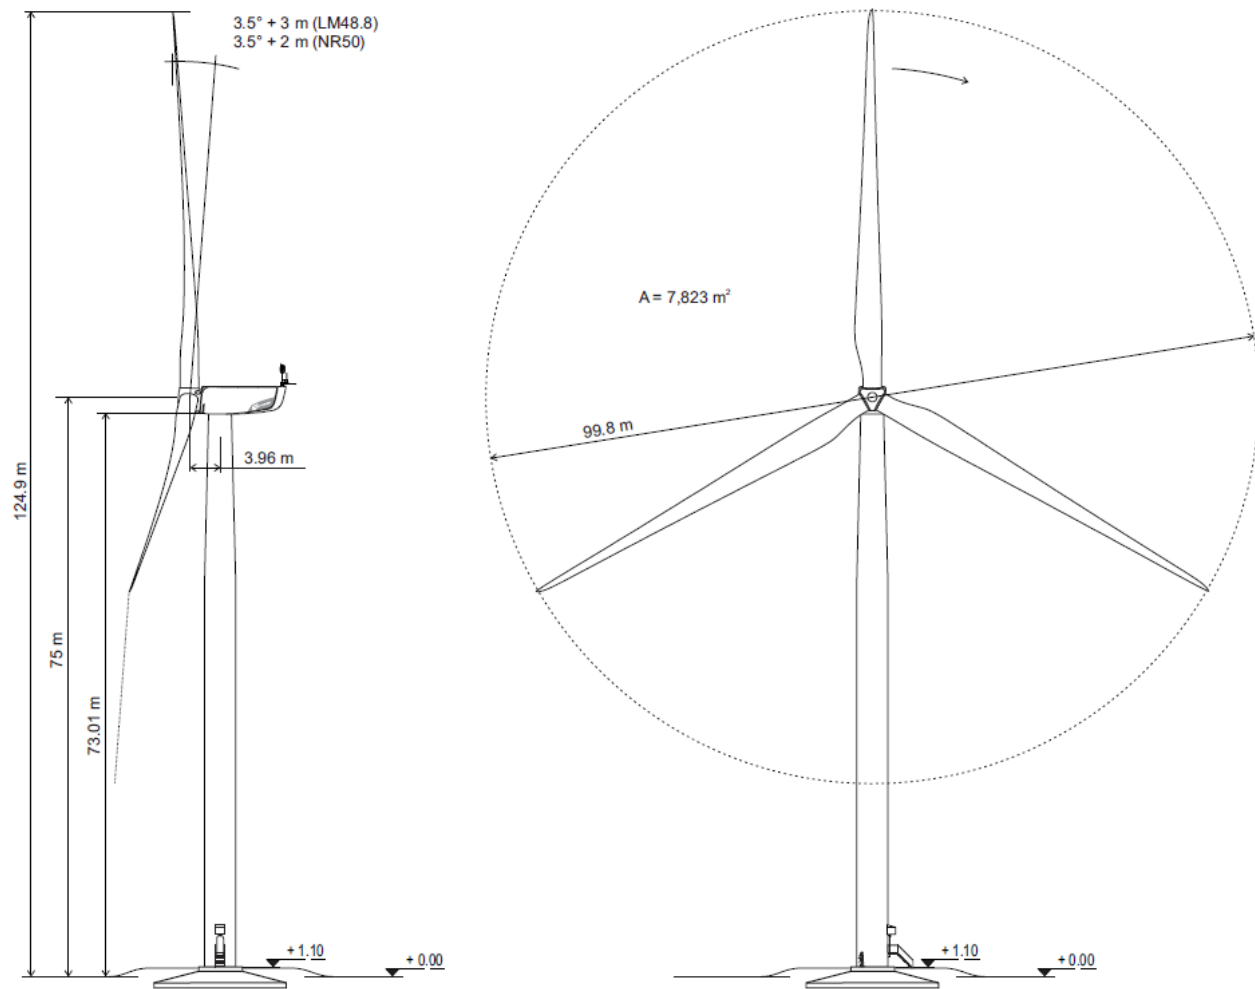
Vue en plan de la Nordex N100-2.5 MW
